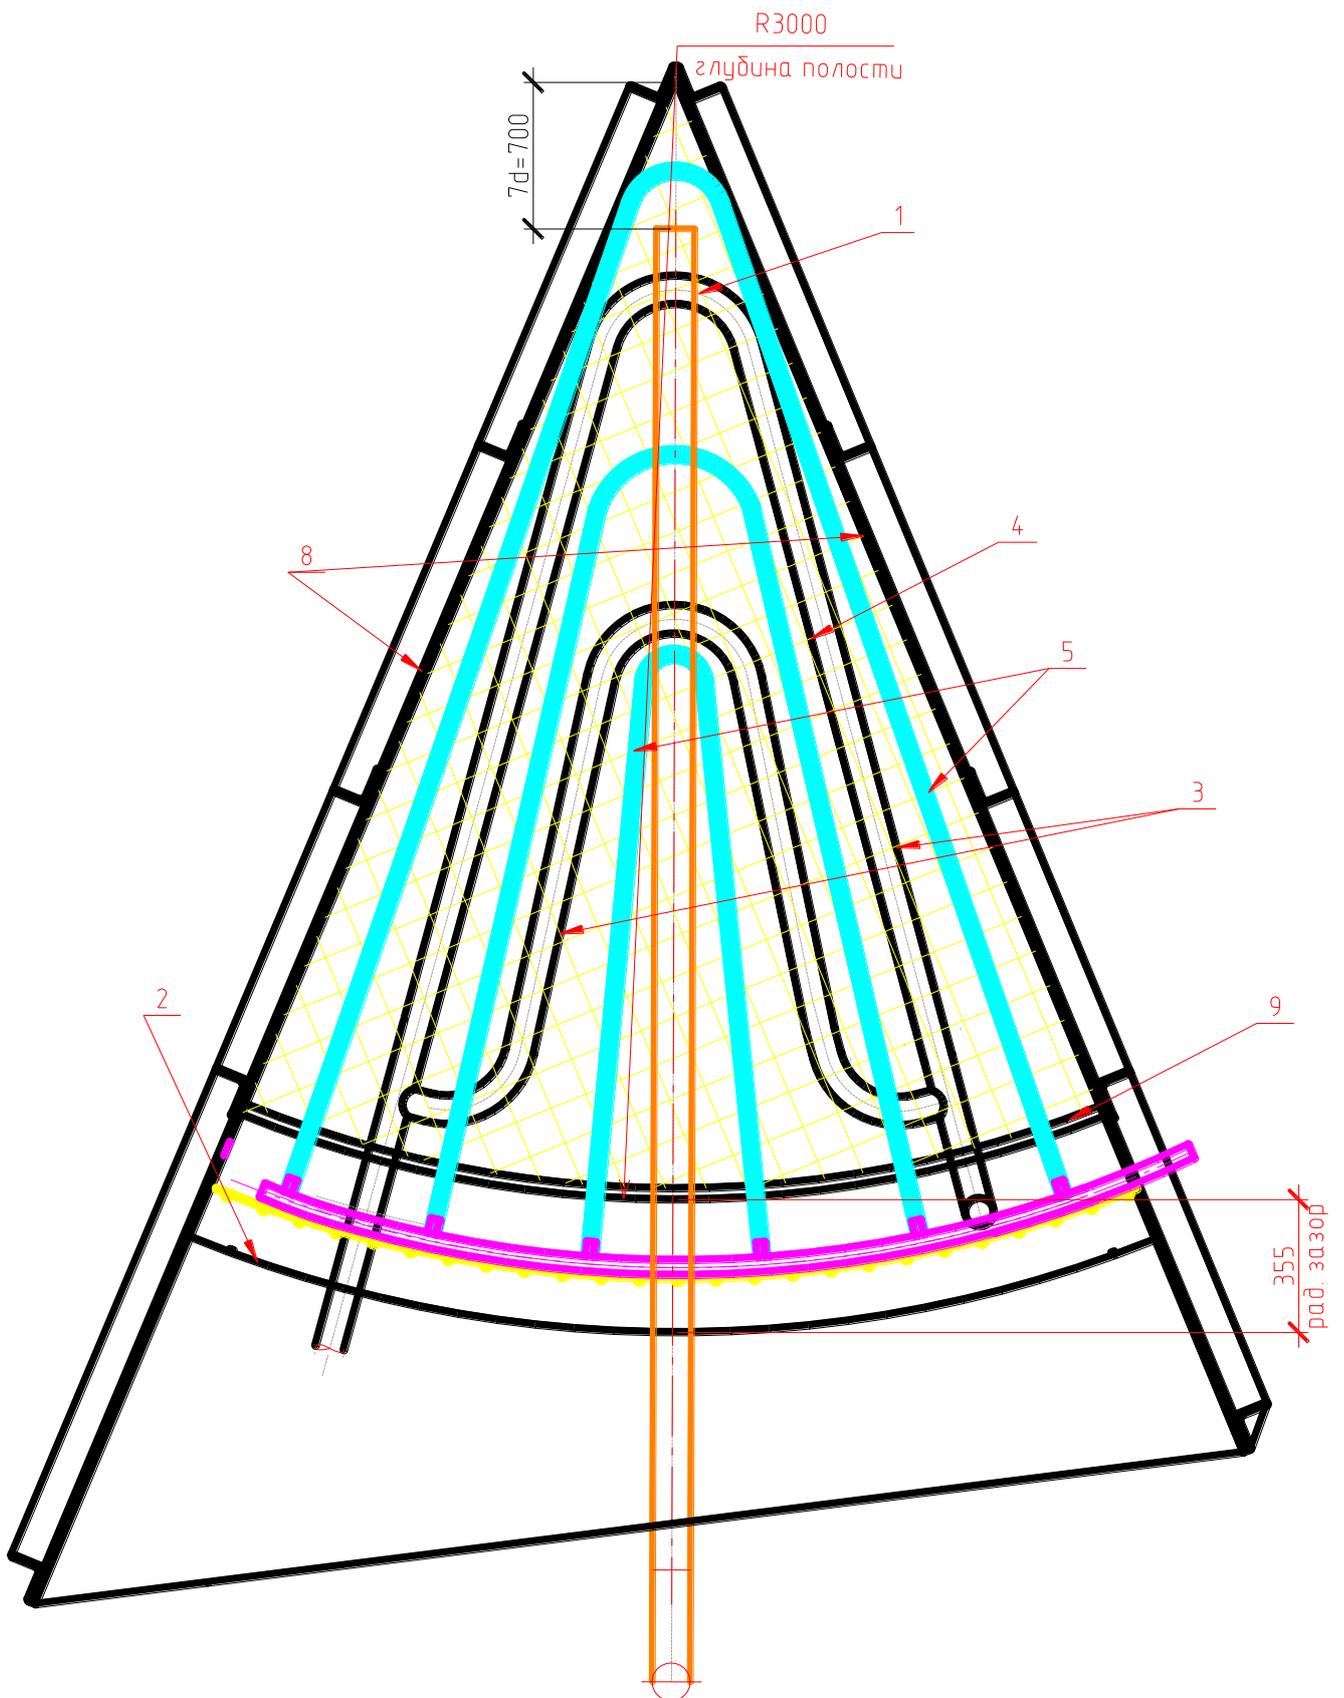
Схема полости(вид сверху): 1 – бетоновод; 2 - кольцевая съемная опалубка; 3 – трубопроводы; 4- арматурная сетка; 5 – гибкие гофрированные трубки; 6 – нижняя металлическая плита; 8-боковая опалубка; 9- оболочка.
